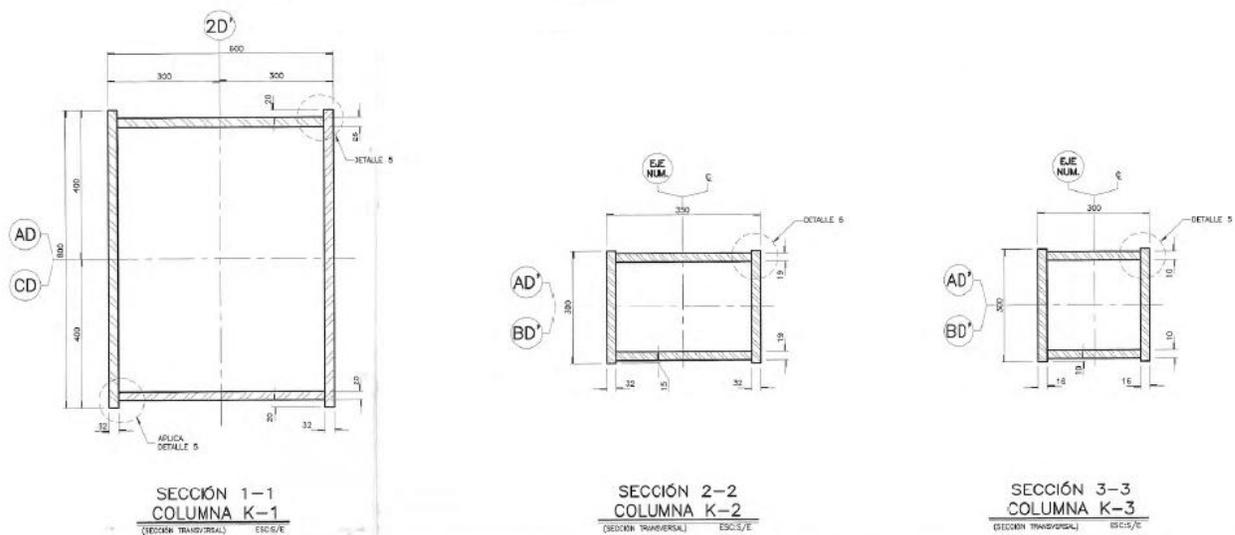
Sección columnas tipo cajón. Columnas Principales K-1, Secundarias K-2 y K-3.
